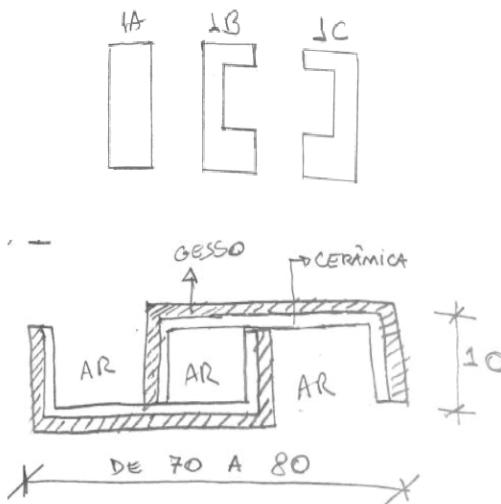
Croqui de peças pré-moldadas para fachada: elevações (1^a, 1B, e 1C) e planta. Acervo do Autor
